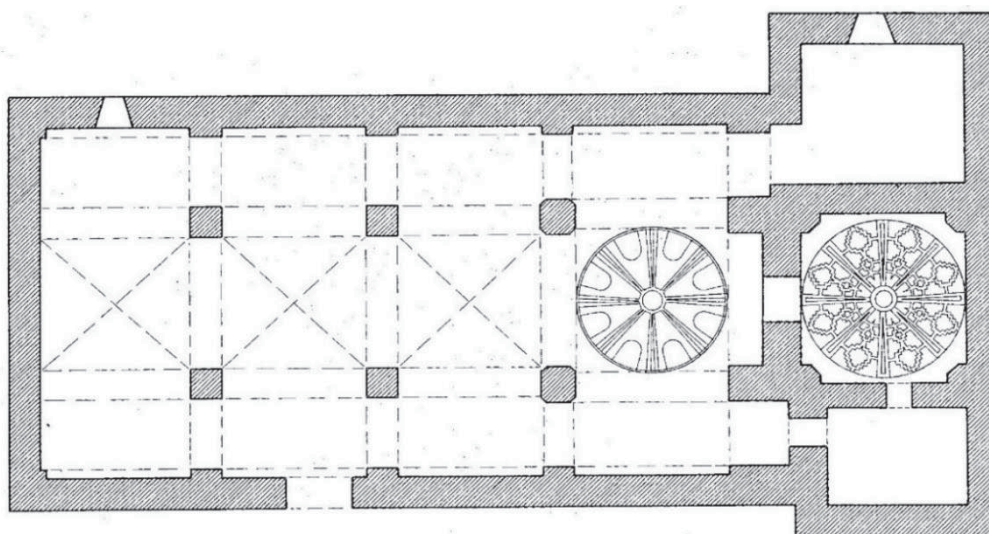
plano de la ermita de Villalón de Campos (fuente: ZALAMA RODRIGUEZ, M. A., *Ermitas y santuarios...*p. 167.)
